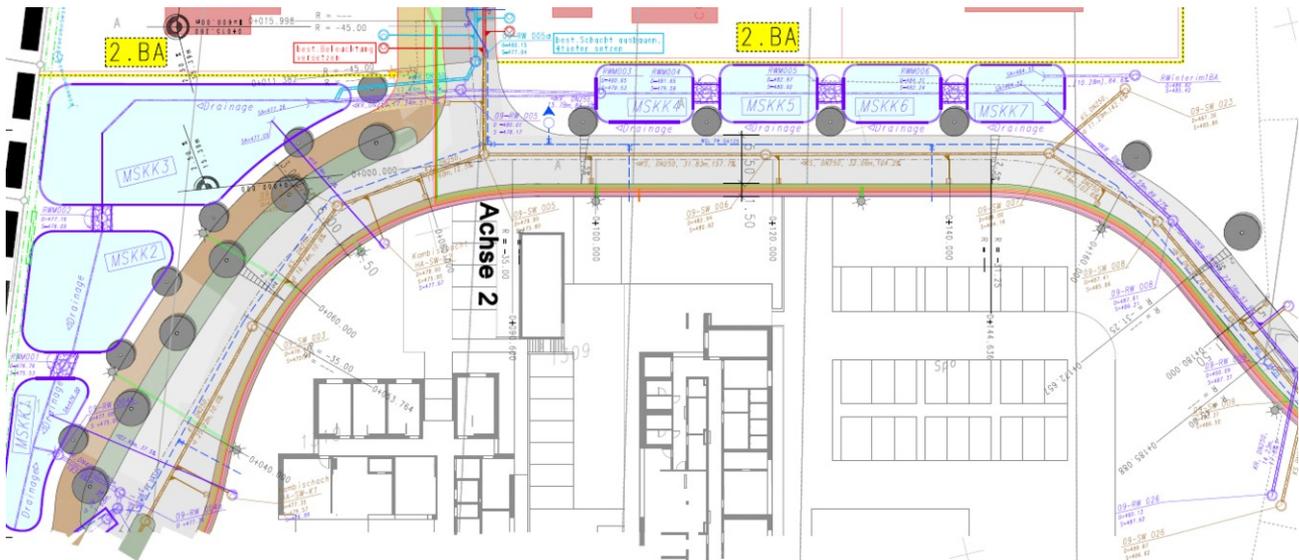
Lageplan Muldenspeicherkaskaden (Güthler Ingenieure GmbH)
